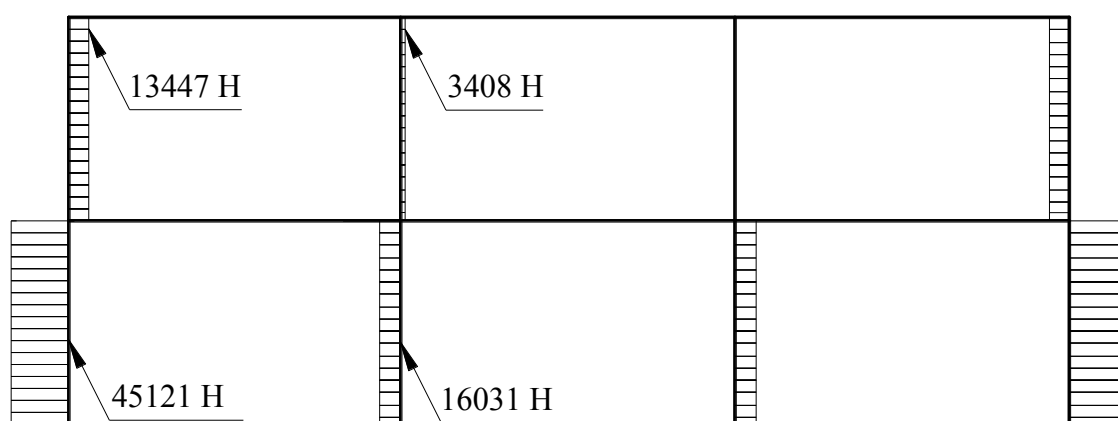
Эпюра поперечных сил для 1 Варианта тепловой нагрузки
